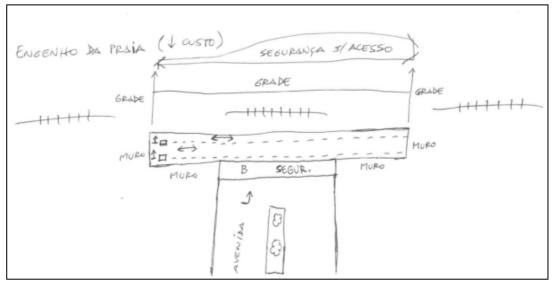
Croqui da estação terminal Engenho da Praia ao final da Avenida Lagomar (elaboração do autor)
